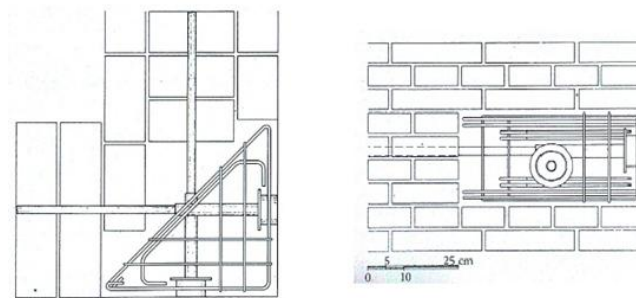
Exemplos de ancoragens de canto realizadas em betão armado pré-fabricado. [5]
